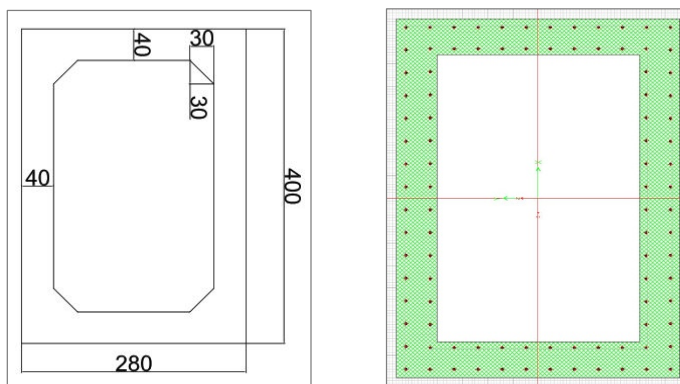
Dimensiones y distribución de refuerzo del travesaño inferior en la pila del tramo de las dovelas de concreto.
